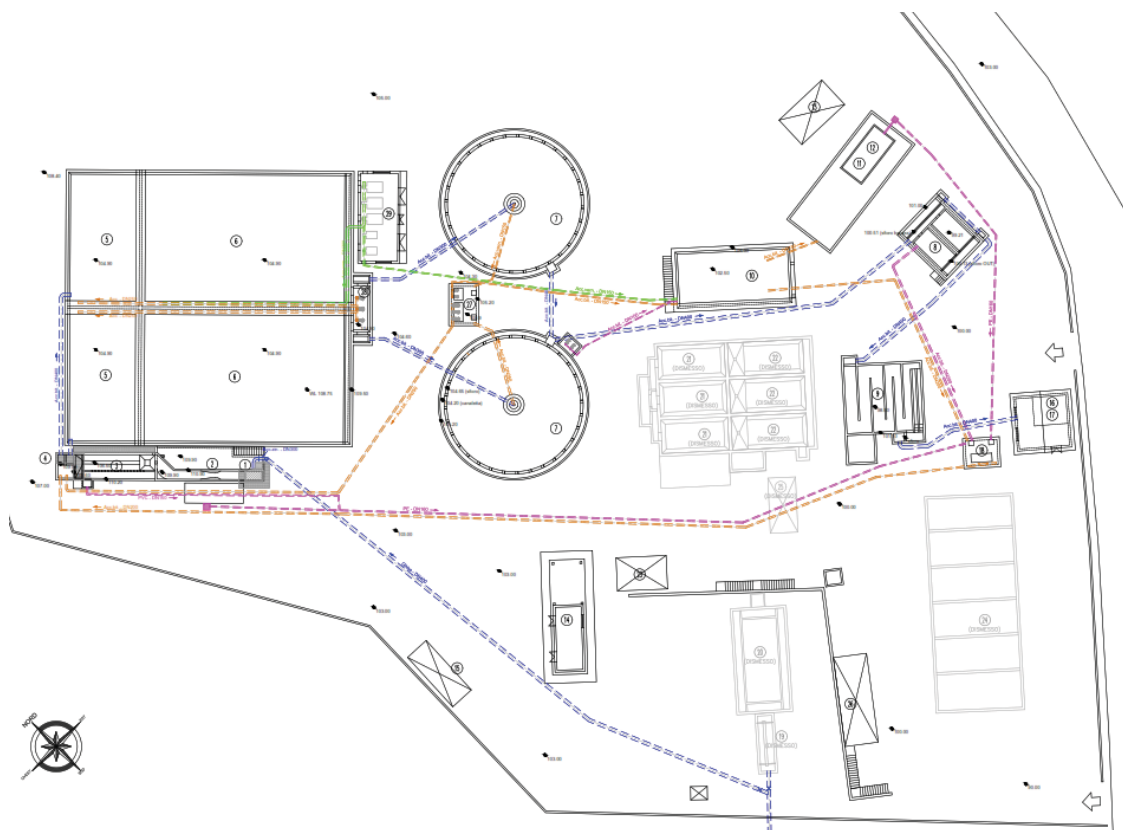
Planimetria stato di fatto con evidenziate le linee (rif. Elaborato 05 Planimetria ante operam)
